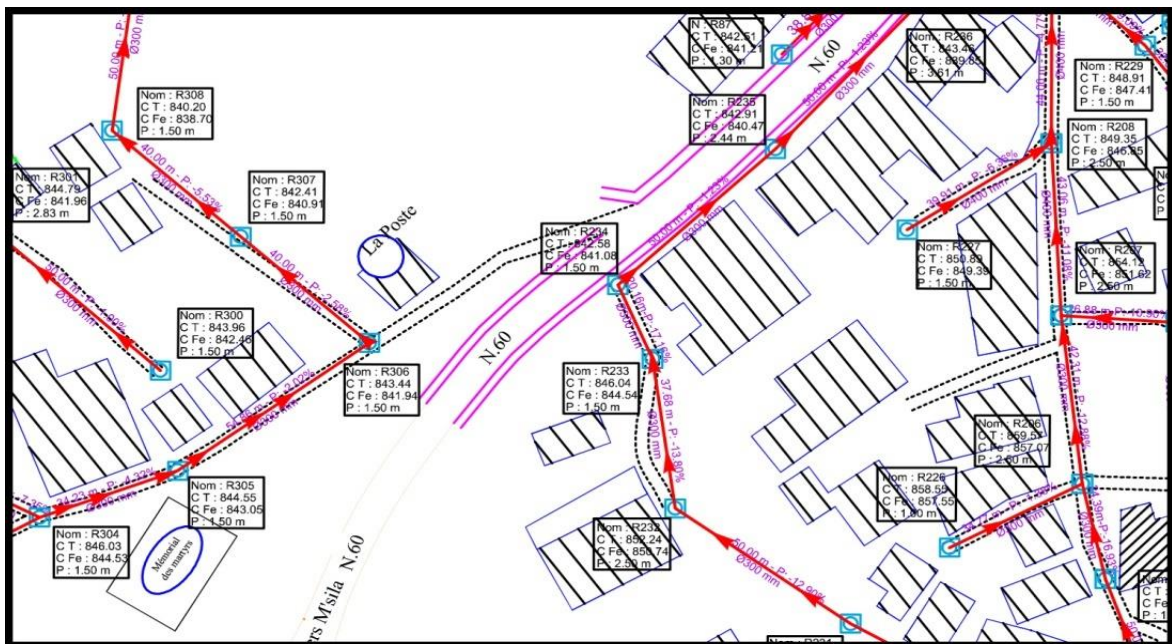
Plan de dimensionnement du réseau d'assainissement (une petite partie)
